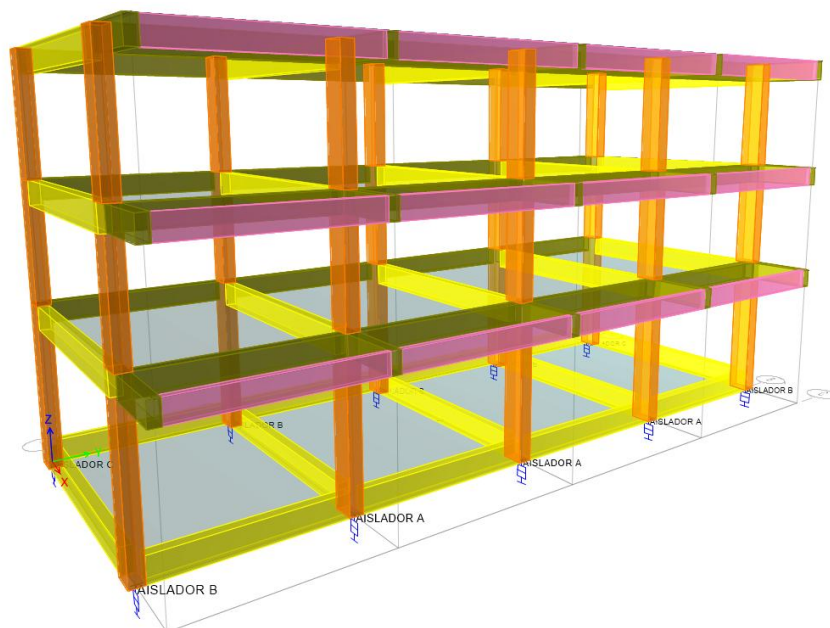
j. Vista tridimensional frontal sistema aislado.
